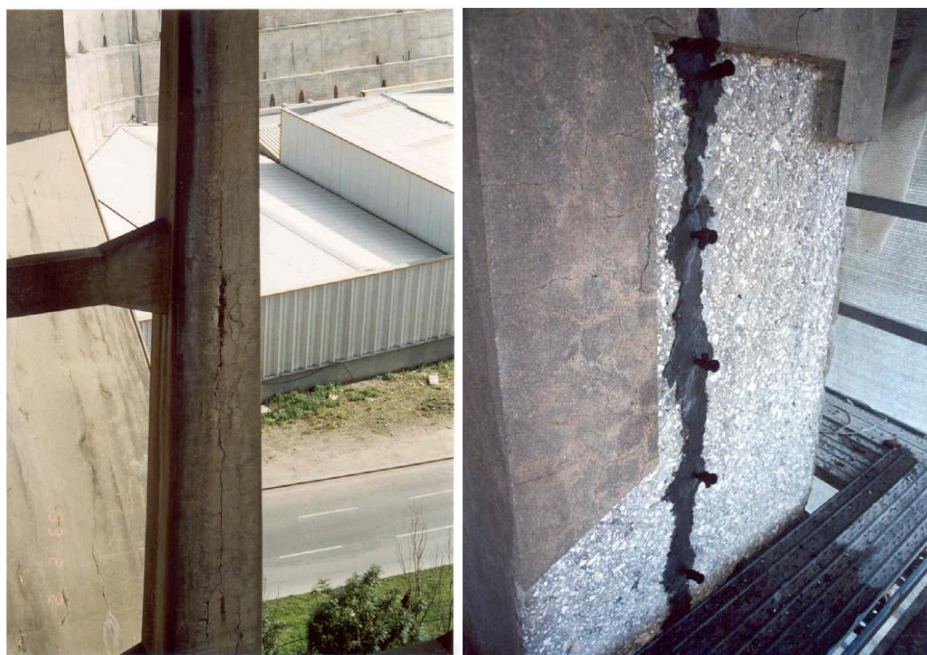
Fendilhação em pilar e trabalho de injeção (APPLETON, J: et al, 2004).
